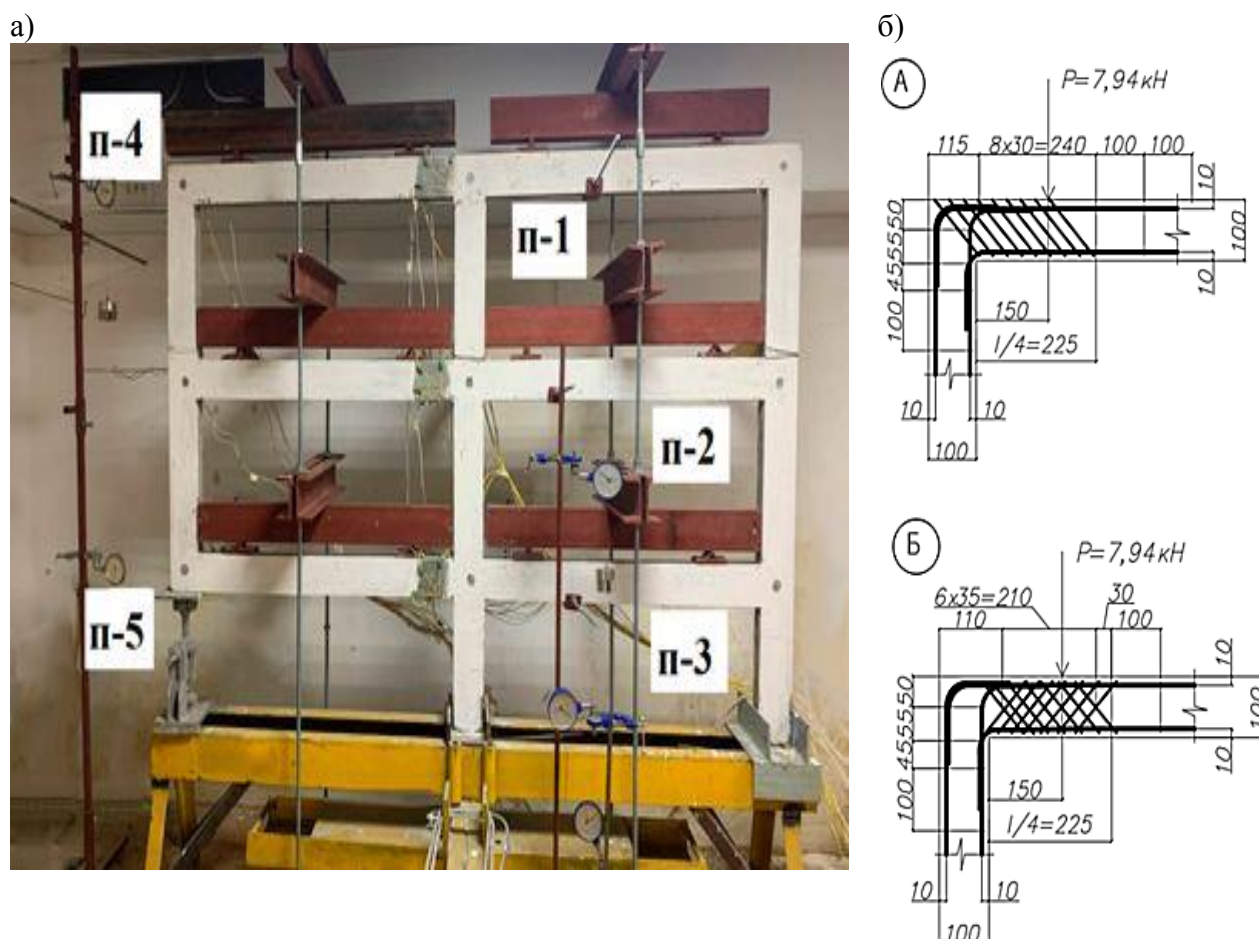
Общий вид опытной конструкции рамы (а) и схемы поперечного армирования приопорных зон (б)
